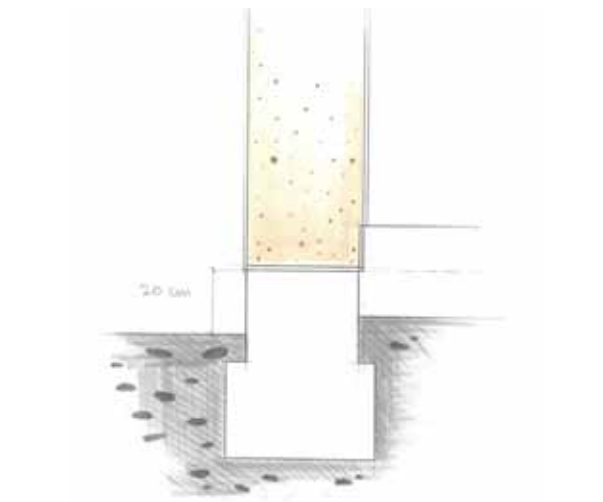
Distanza minima dal terreno di una parete in calcecanapulo
